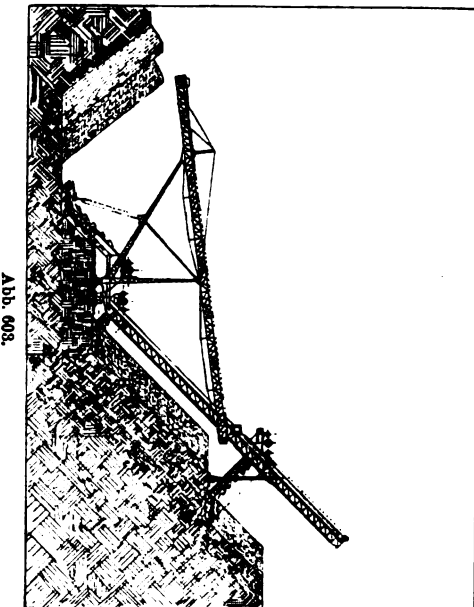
603. Bagger mit verschiebbaren Becherwerken (Lübecker Maschinenbaugesellschaft).
